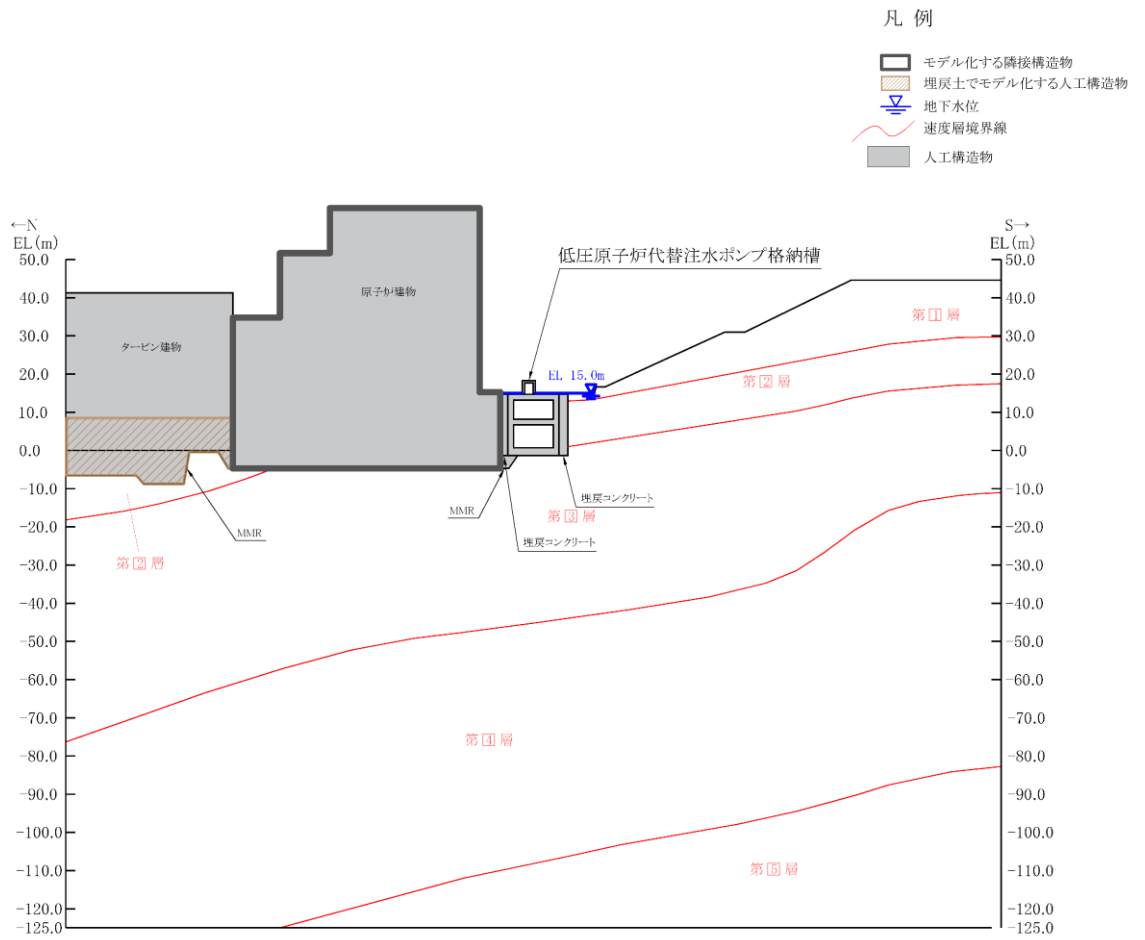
低圧原子炉代替注水ポンプ格納槽断面図 (A-A断面位置)
